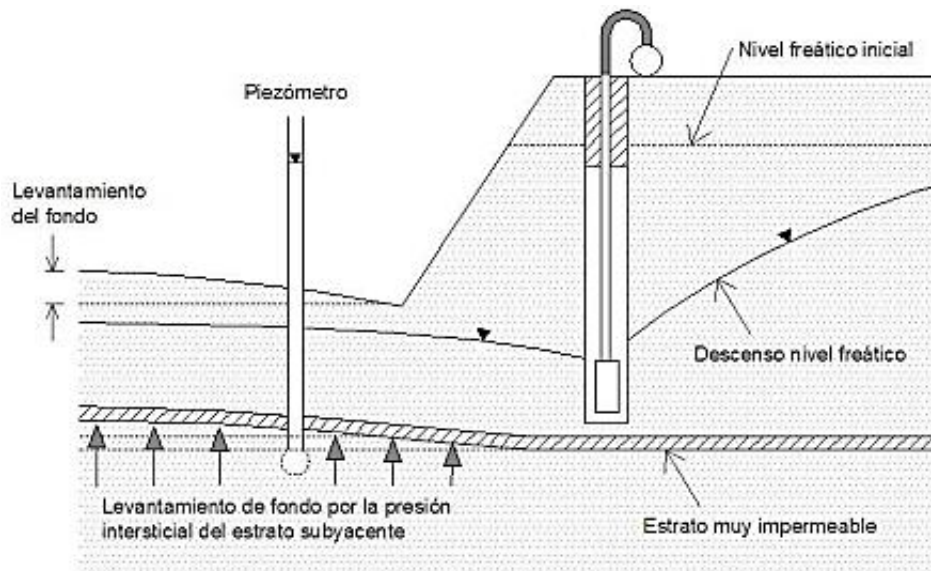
Levantamiento de fondo (CIRIA C750, 2016).
